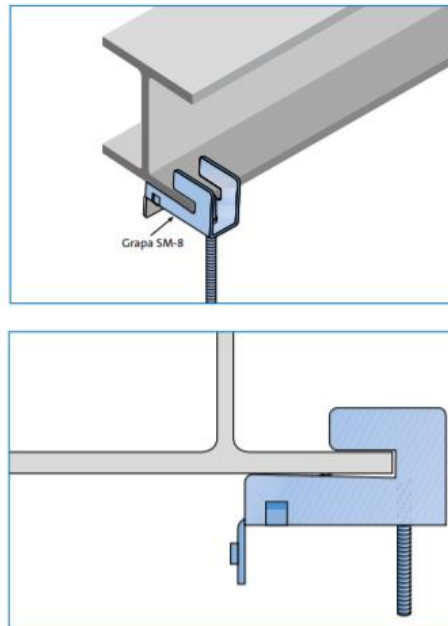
Unión entre los perfiles de cubierta y el falso techo.
